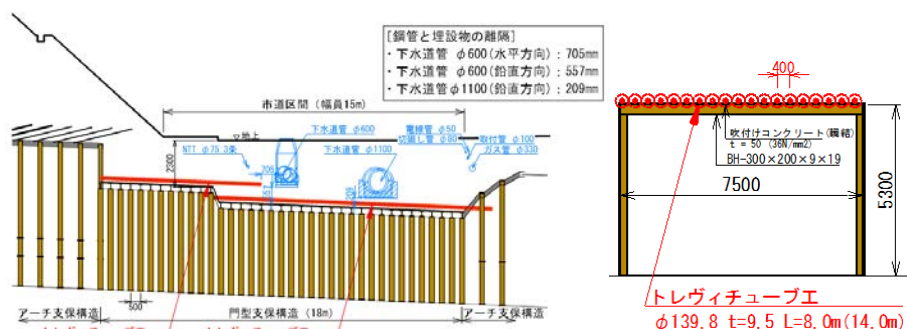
市道直下でのトンネル縦断面図および門型支保断面図
